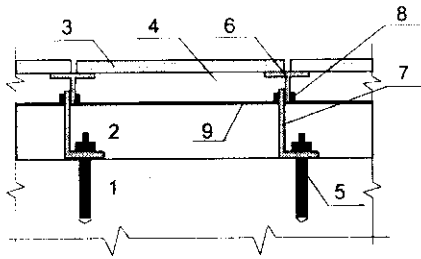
Конструкция вентилируемого фасада с вертикальным расположением направляющих:
